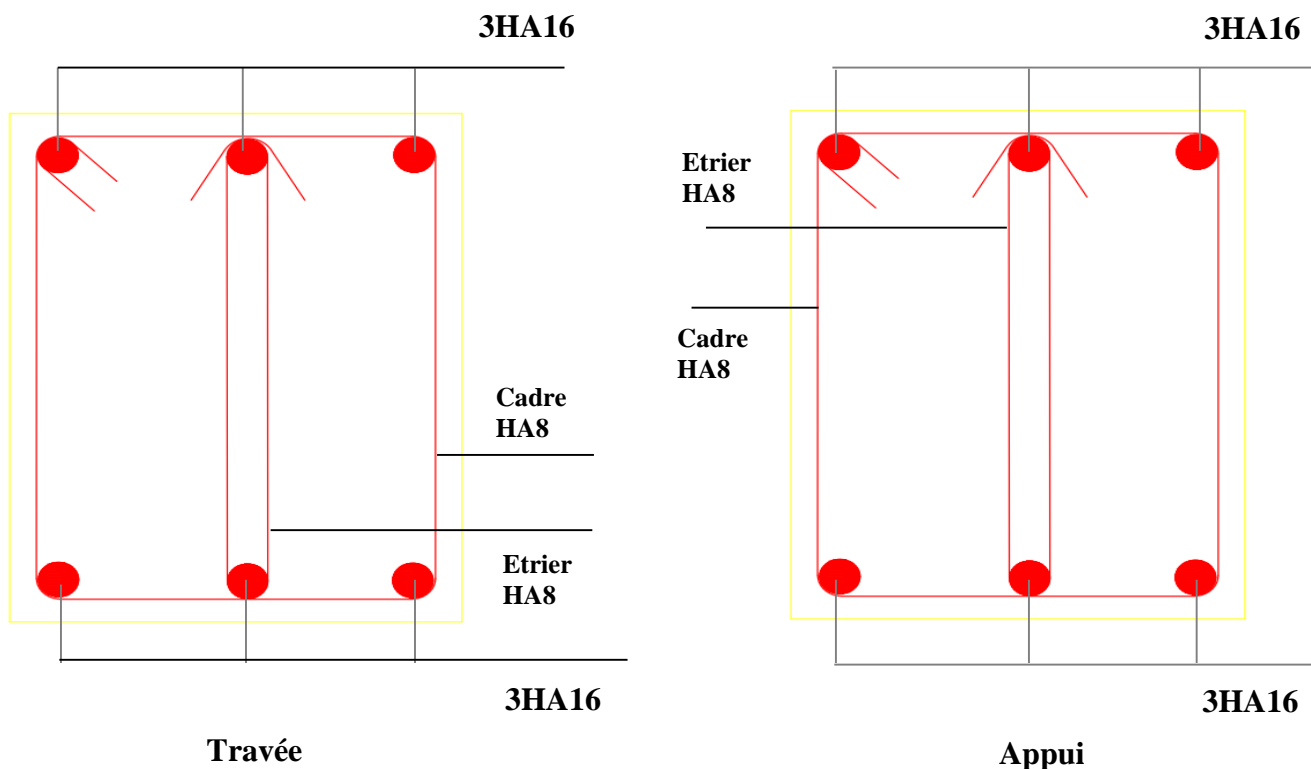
Schéma de ferrailage poutres secondaires E.sol et S.sol, RDC, étage 4 jusqu'à étage 10
